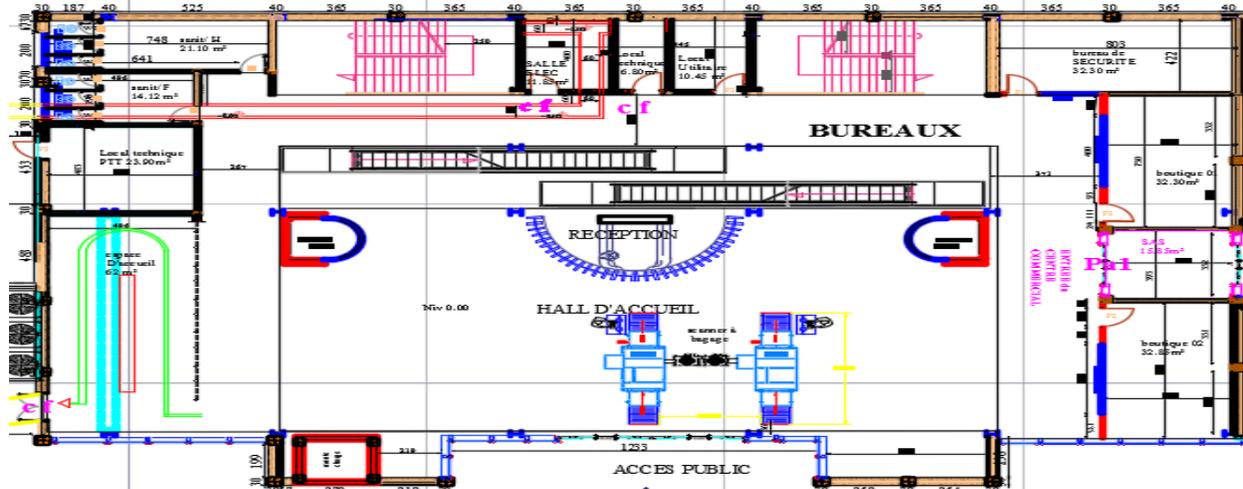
Plan du Rez-de chaussée par obtenue la direction de transport..
